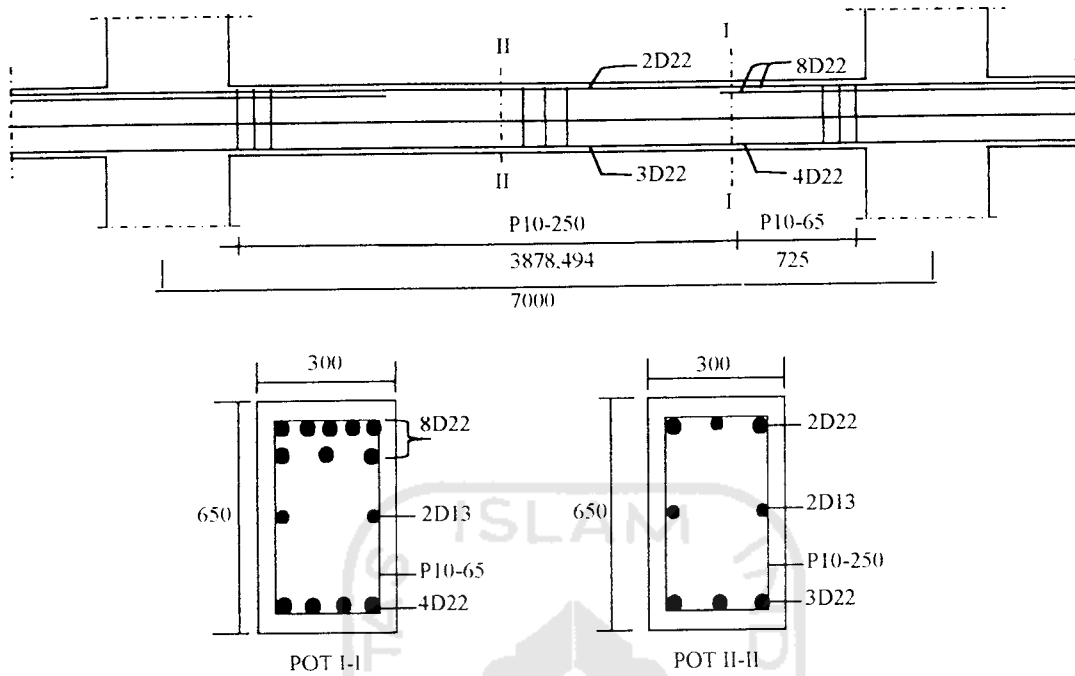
Balok Portal E Bentang 7 m Lantai 4
